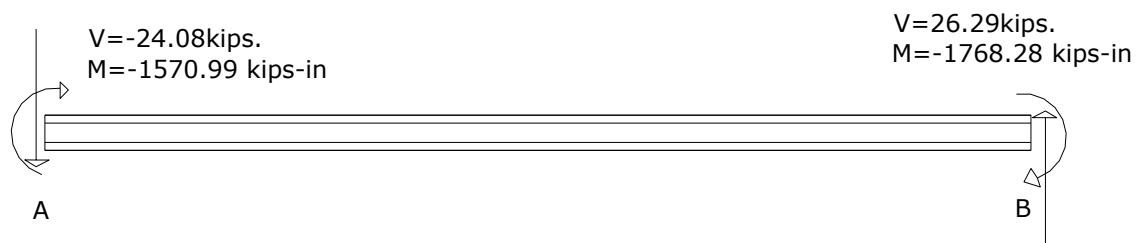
Acciones internas en las conexiones de la viga A-B.
